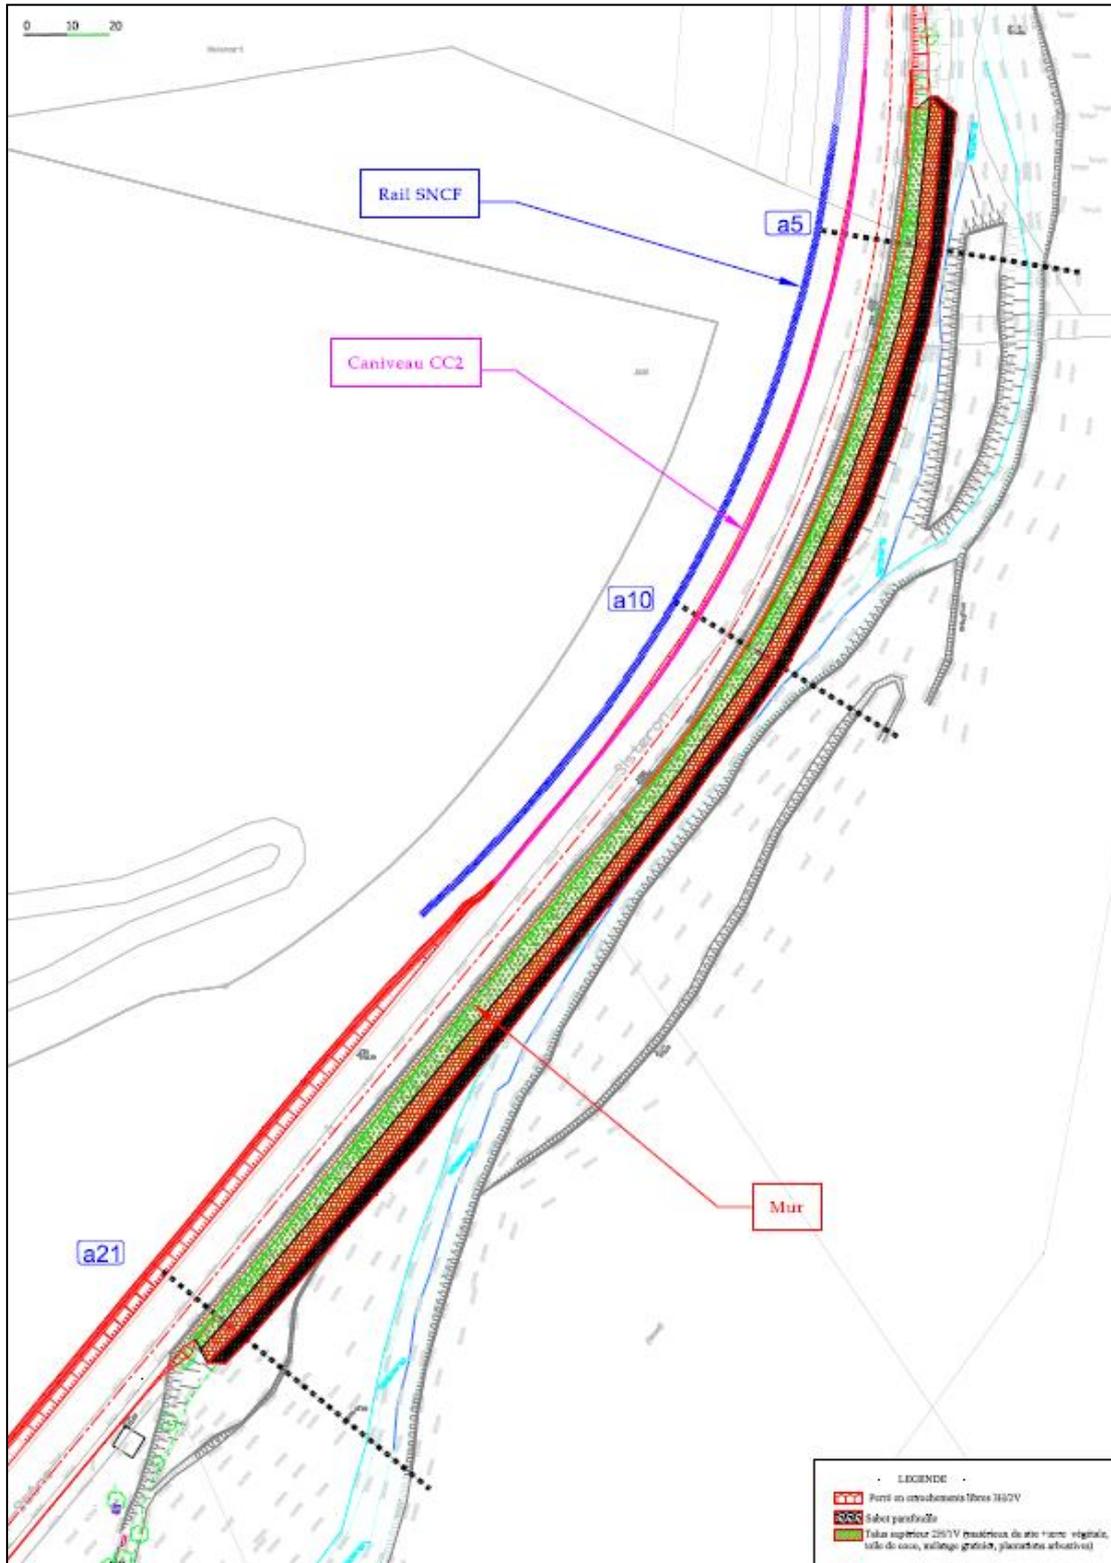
Site 0 : vue en plan des aménagements au profil a10
